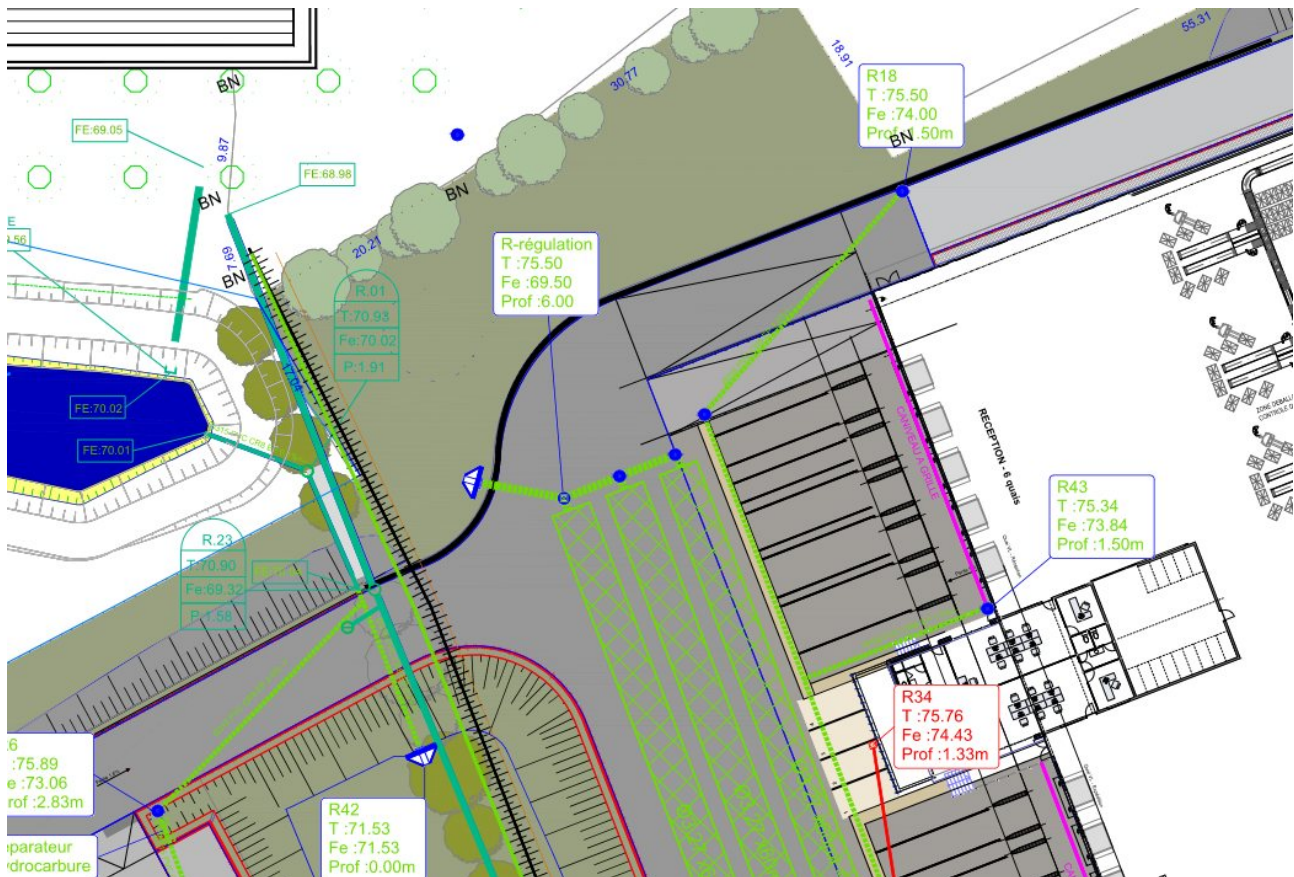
Extrait du plan masse – Localisation du rejet des ouvrages de rétention des eaux pluviales
